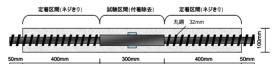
鉄筋埋設ひび割れ試験用供試体
